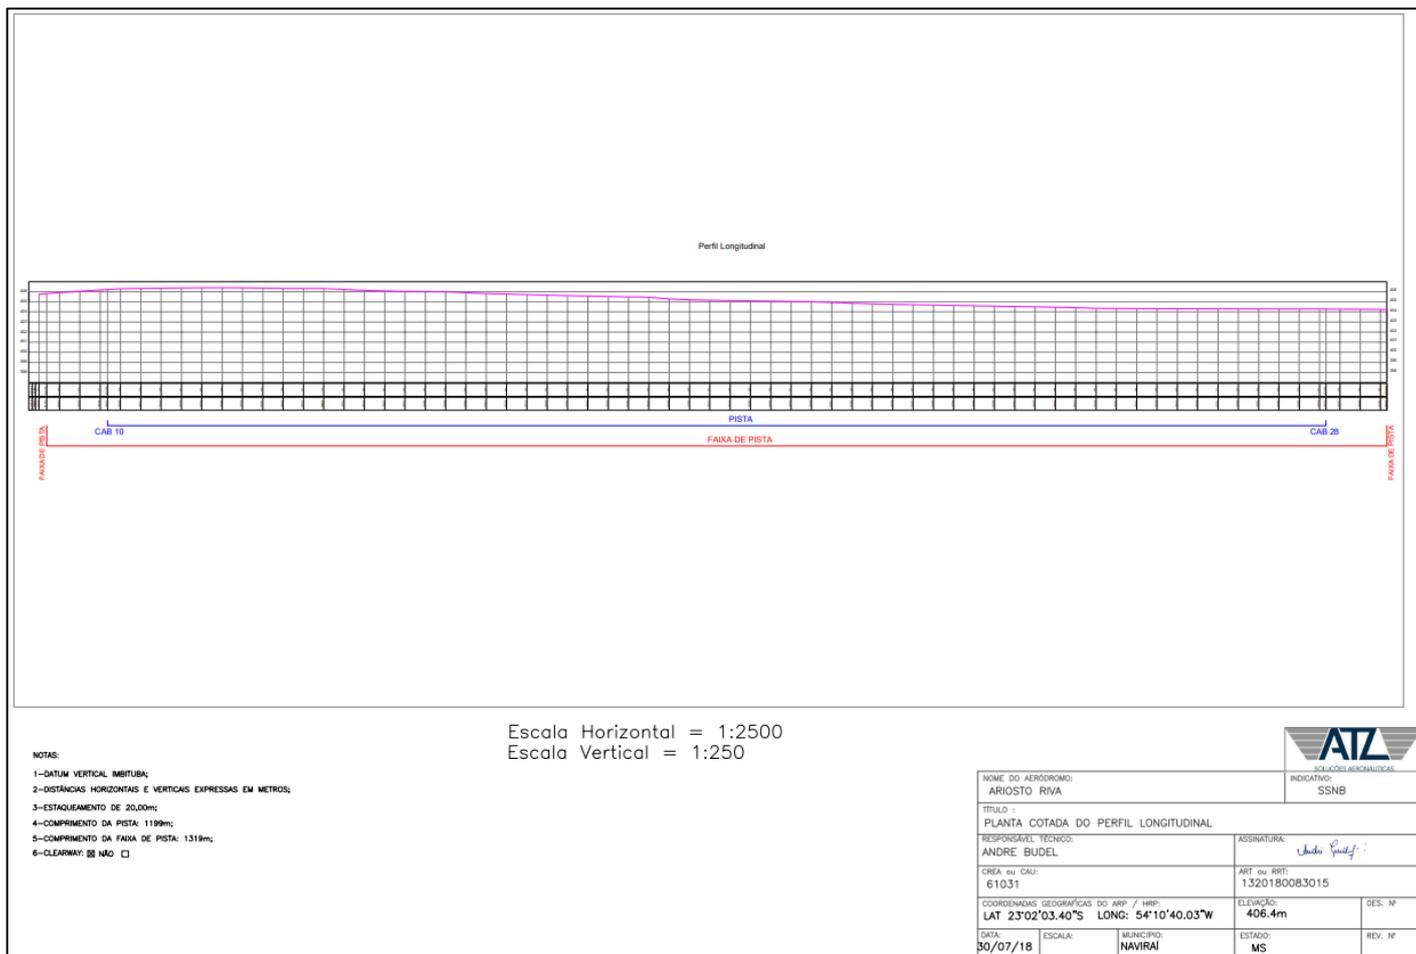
SSNB: planta de elevações do perfil longitudinal da PPD
